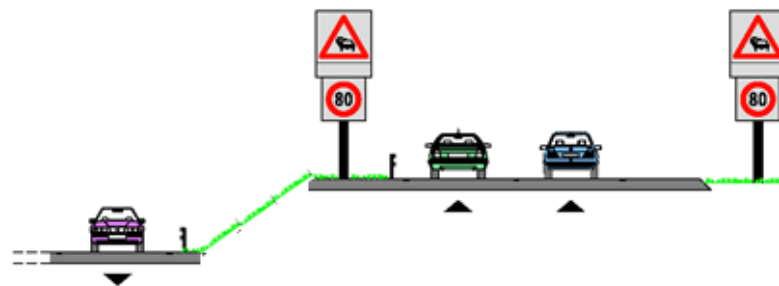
Disposition latérale des HV-AD dans les cas exceptionnels, p. ex. lorsque les chaussées sont décalées verticalement.
